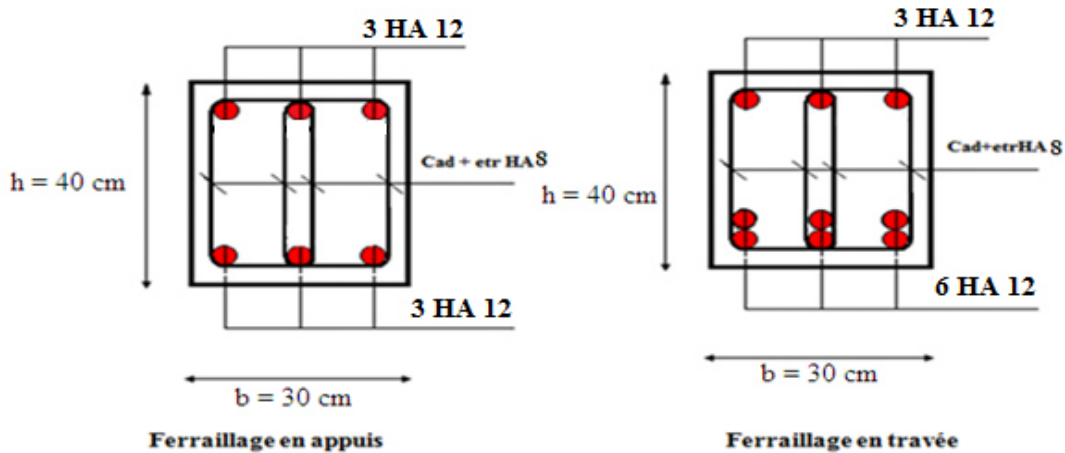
Schéma du ferrailage de la poutre palier.
